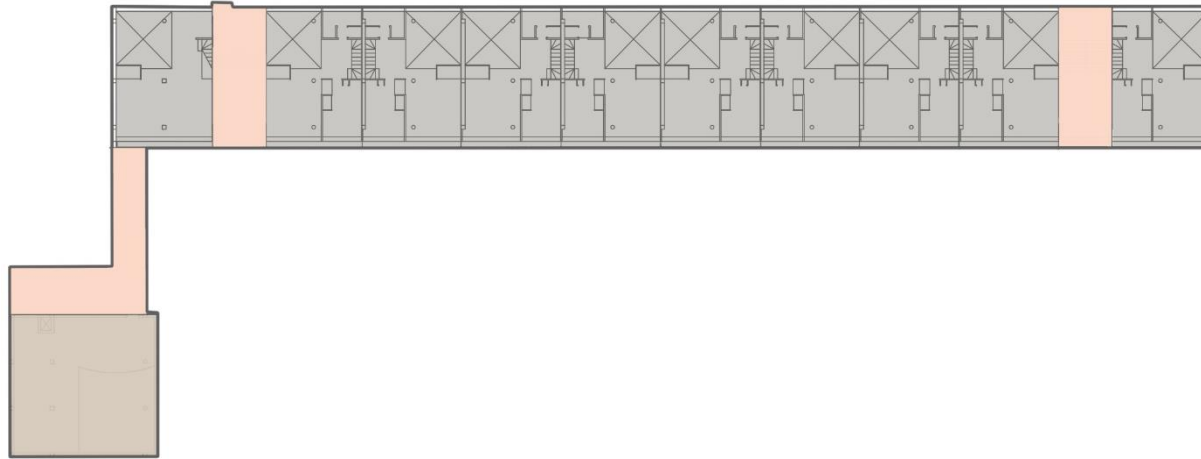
Esquema zonificación planta segunda. Fuente: Elaboración propia
